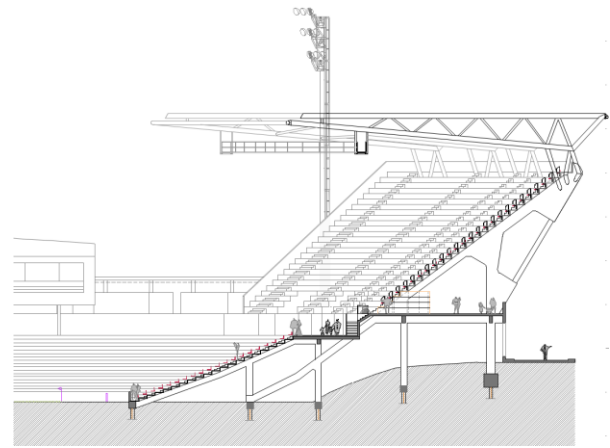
Sección en perspectiva de diseño de cubierta propuesto.
